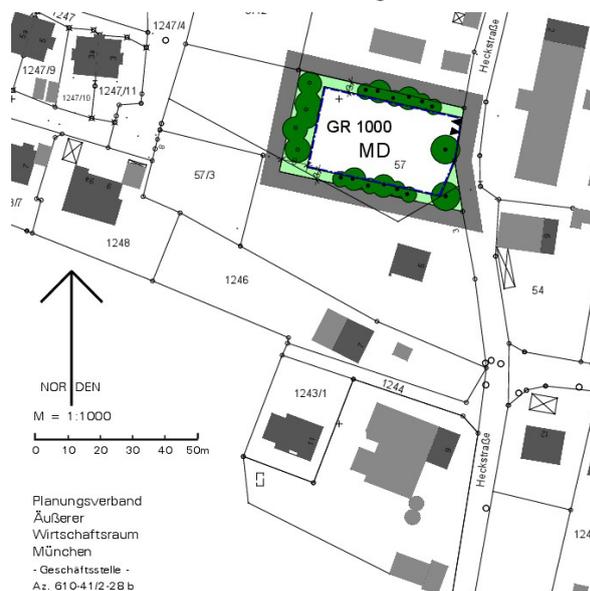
1. Änderung des Bebauungsplans „Dießen IV b – Heckstraße für die nordöstliche Teilfläche von FINr. 57 Gemarkung Dettenschwang“ (Kopie der Planzeichnung, ohne Maßstab)
